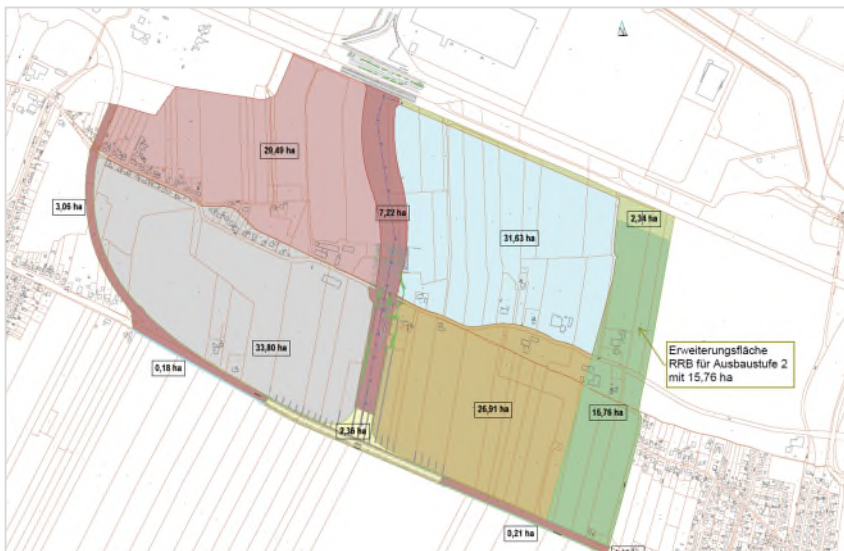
Skizze zu den zu entwässernden Flächen, CONTUR, 30.04.2024
